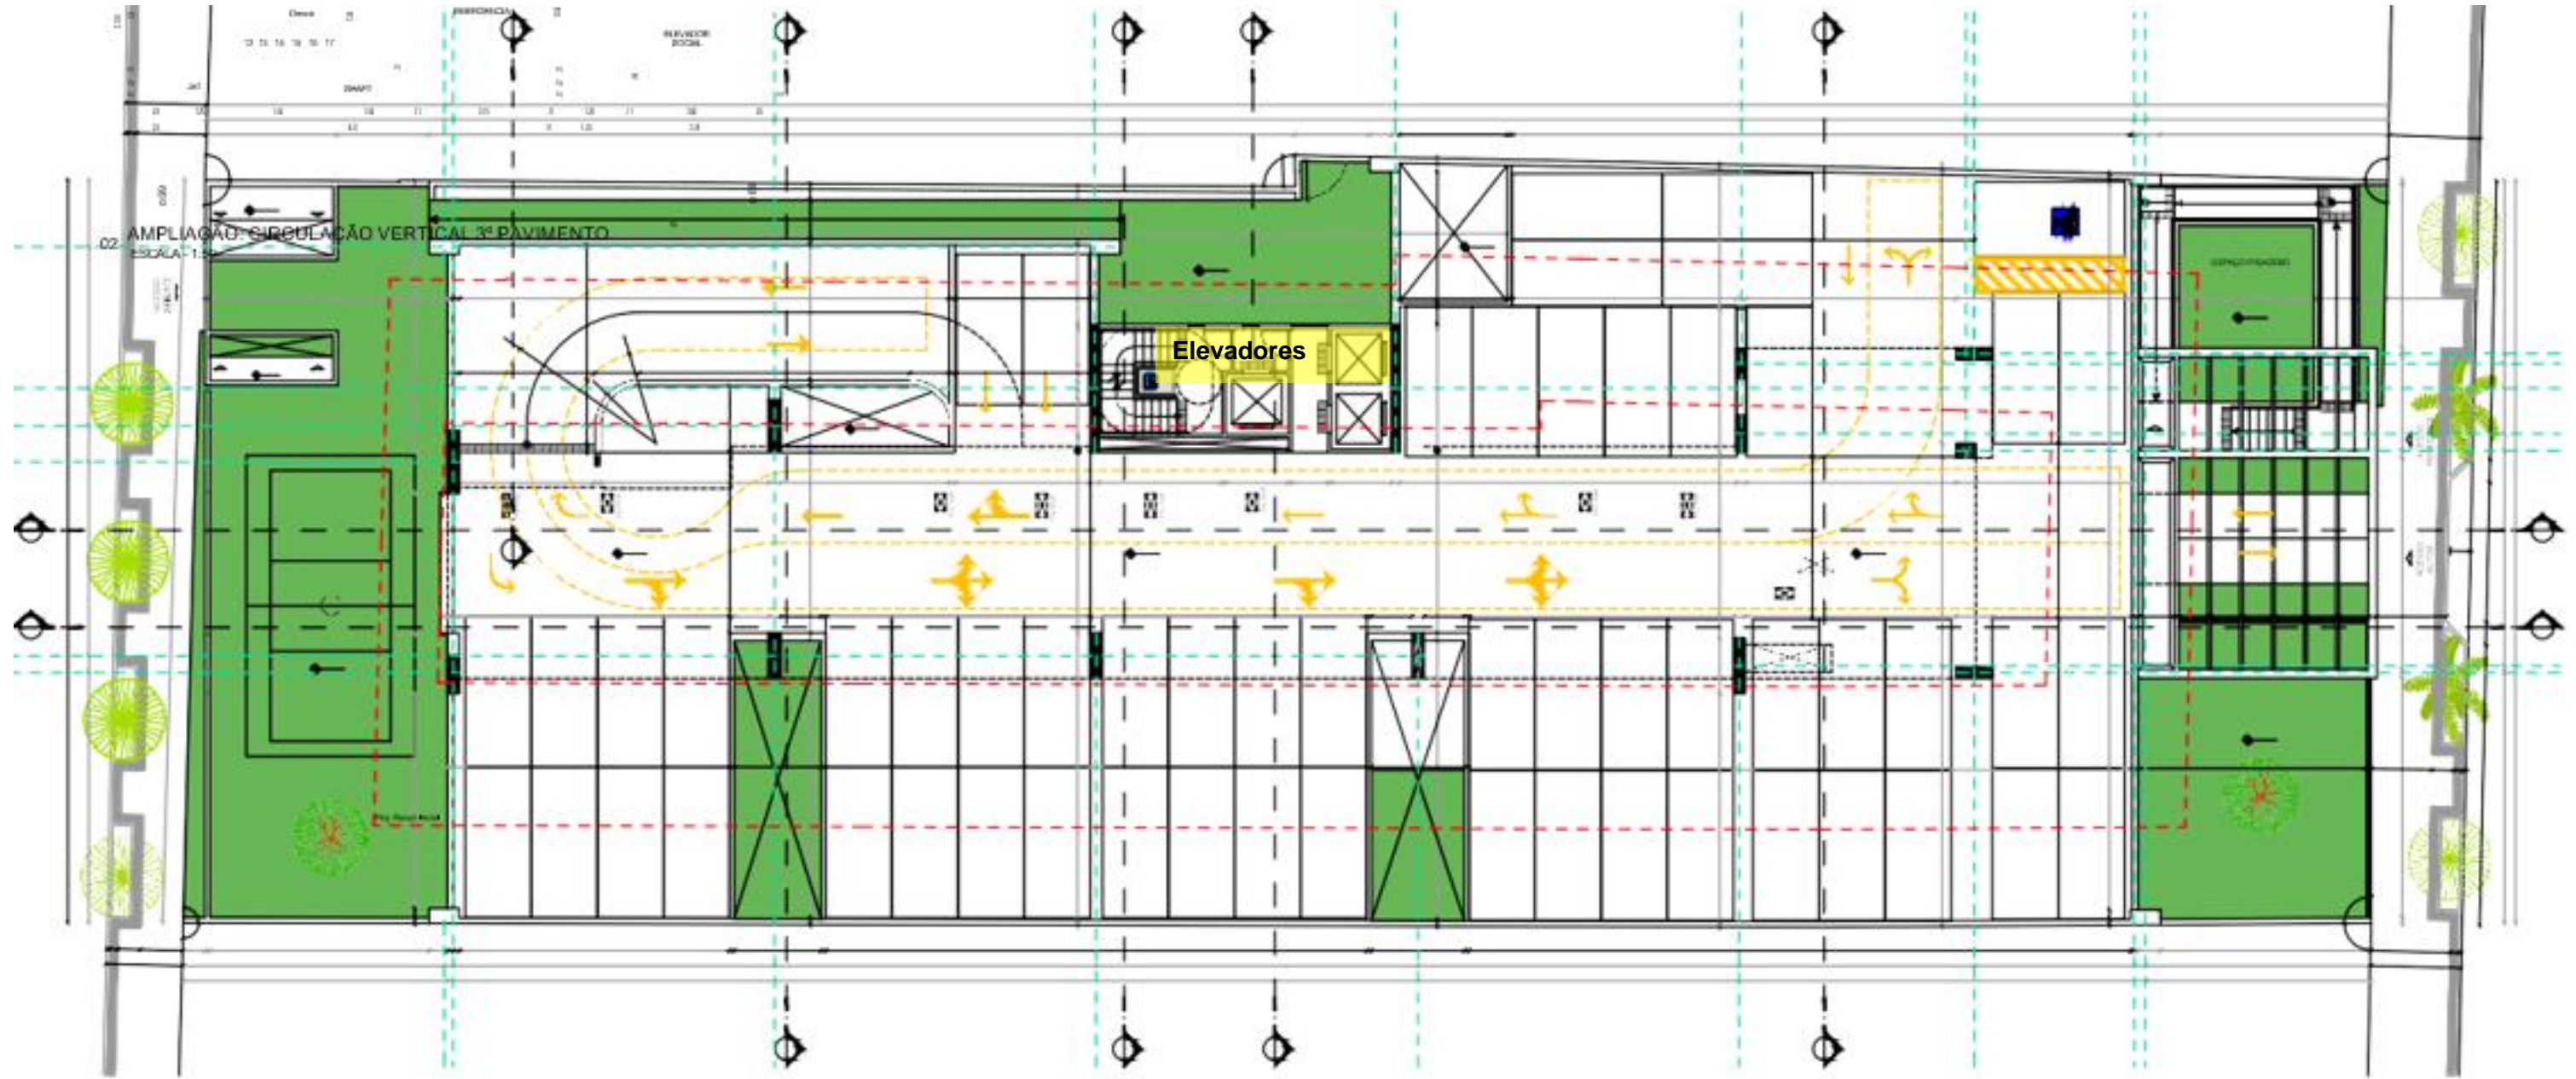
Planta Baixa 3º Pavimento – P05.13.
